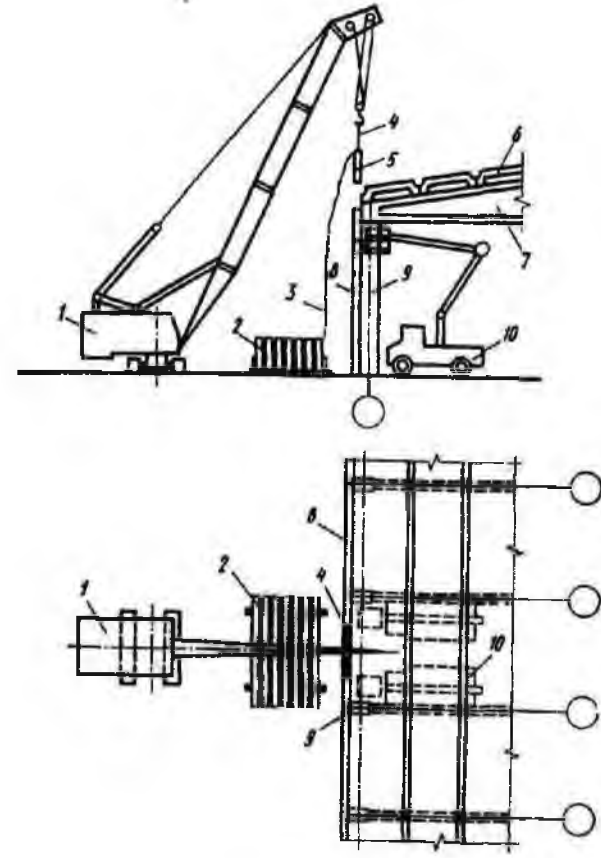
Схема монтажа стеновых ограждающих панелей, кран расположен между кассетой и стеной:
